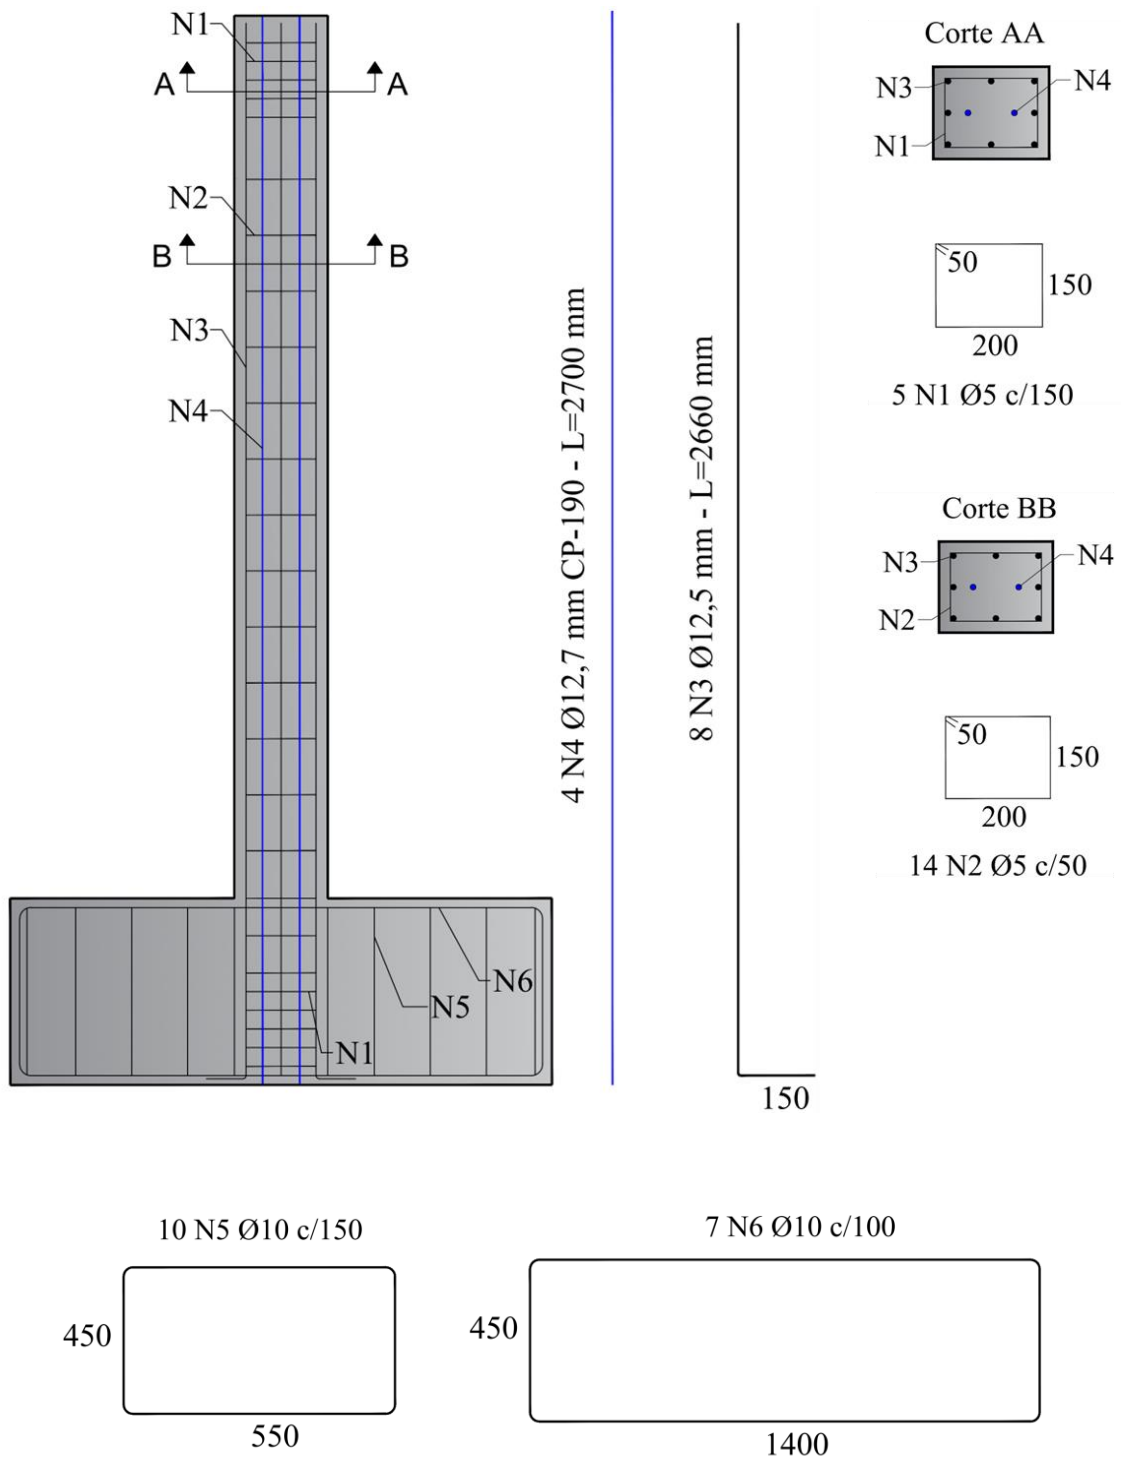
Armaduras do pilar P5 - dimensões em mm (Fonte: Autor)
